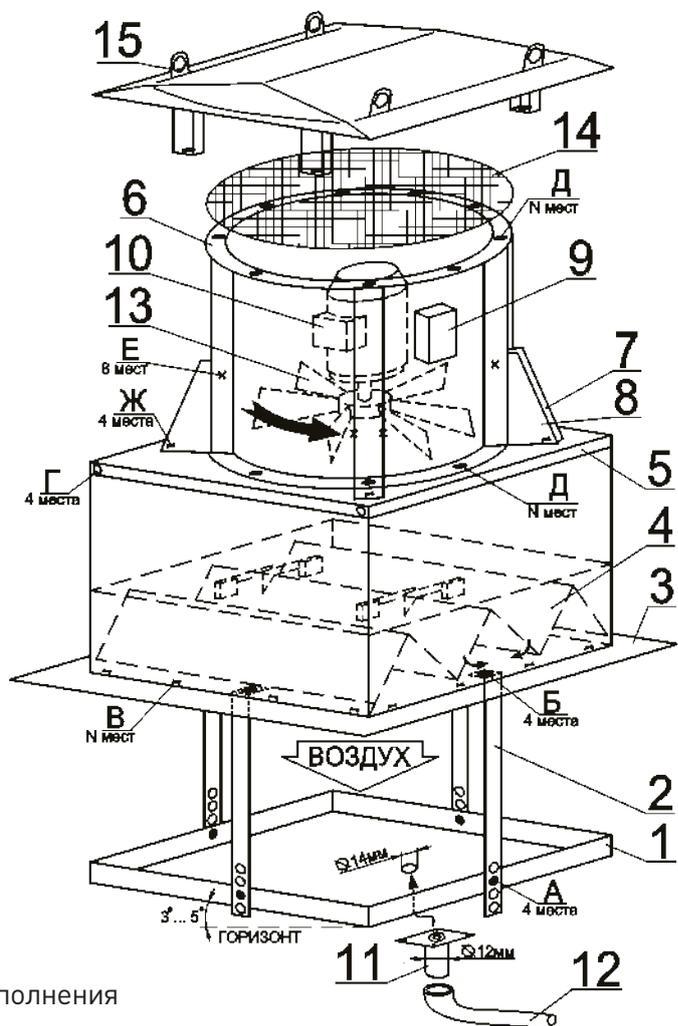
Схема монтажа вентилятора крышного исполнения
